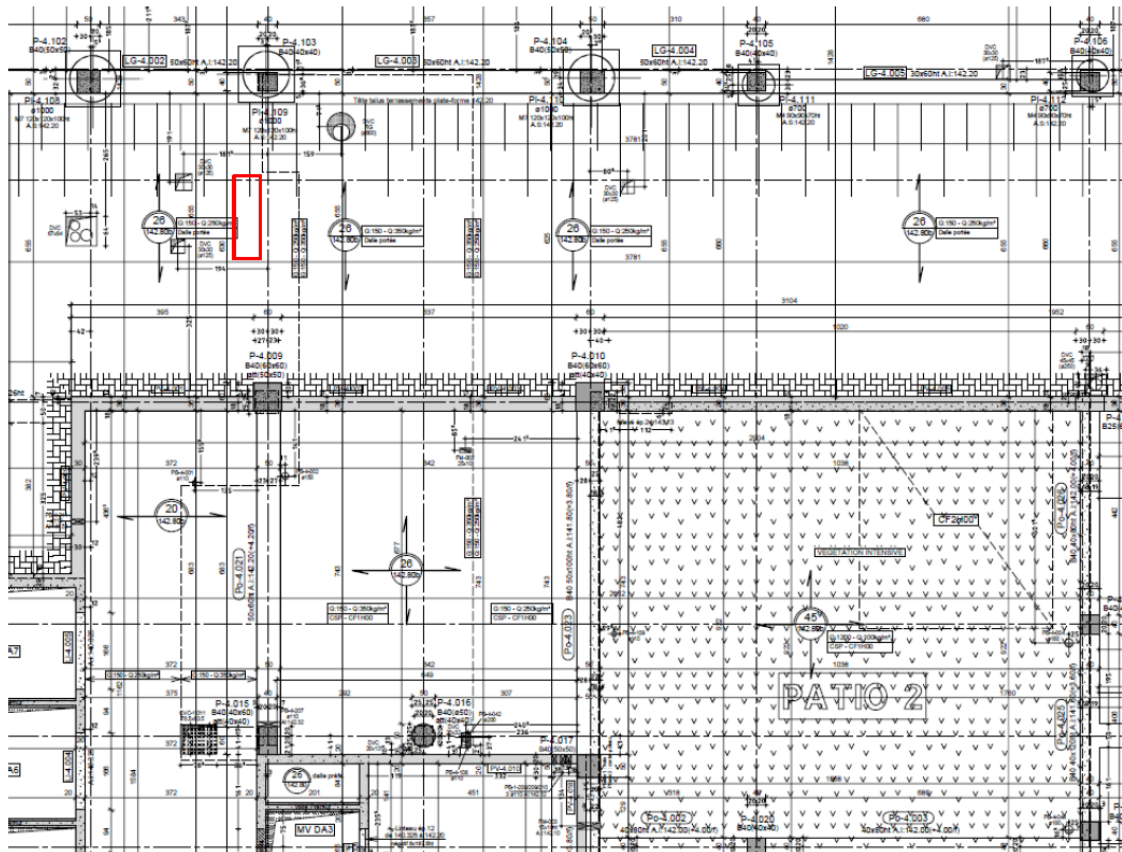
Emplacement de l'armoire de traitement d'air sur le plan structural (PH RDC)
